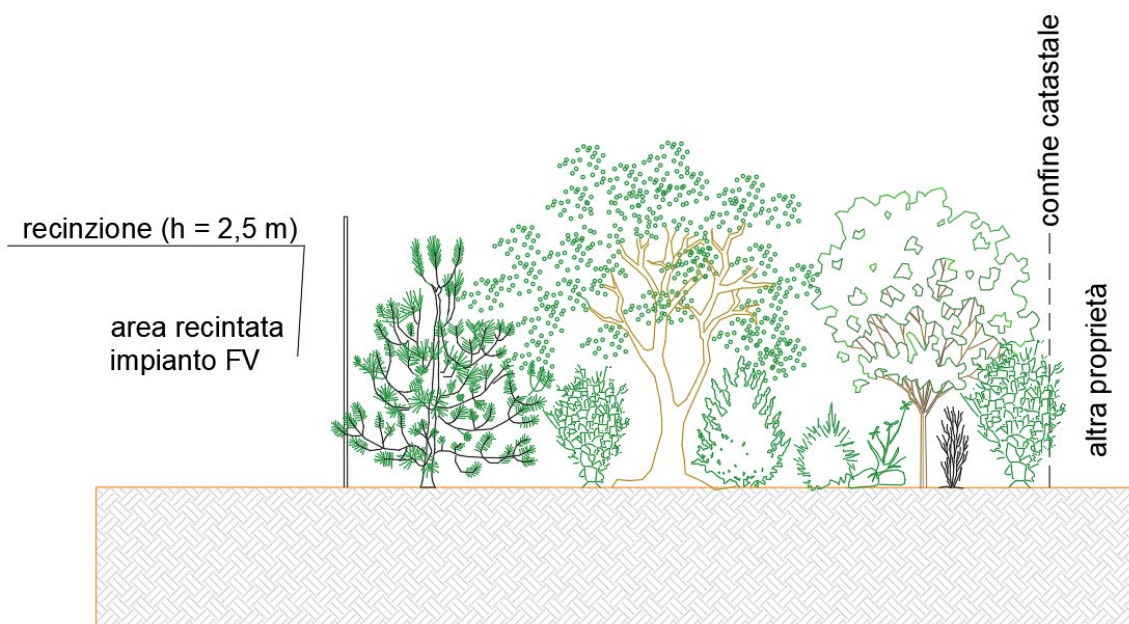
Stralcio sezione della siepe (area perimetrale dell'impianto)
